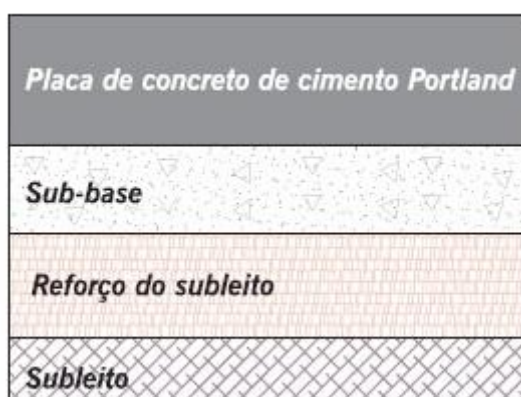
Estrutura de pavimento-tipo. Fonte: Ceratti et al., 2008.
